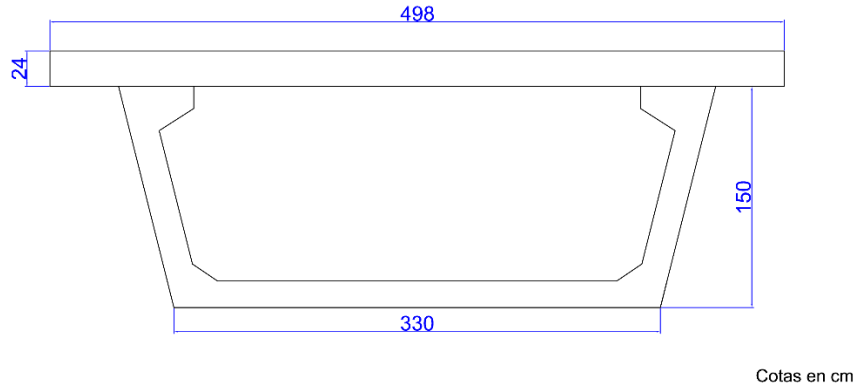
Sección homogeneizada de la viga + losa de compresión
